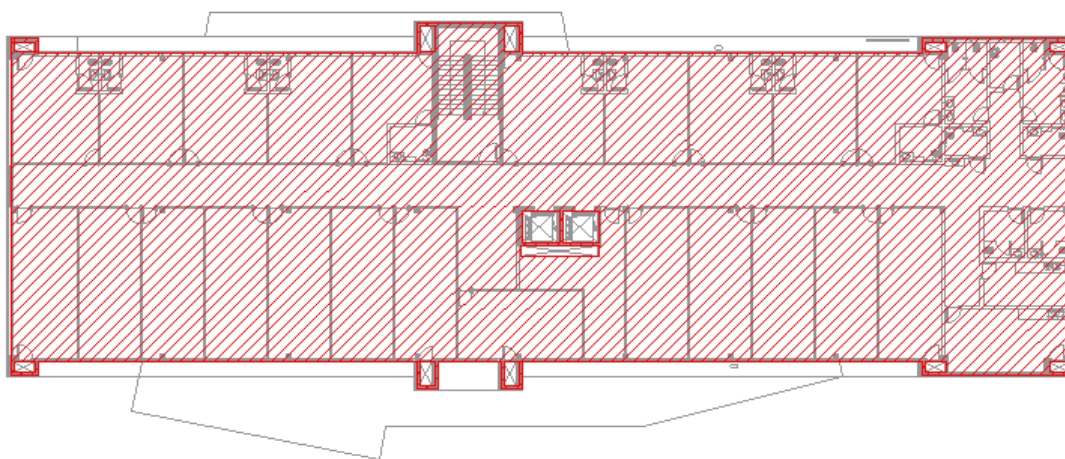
Área considerada para pavimento tipo (2º Pavimento)
